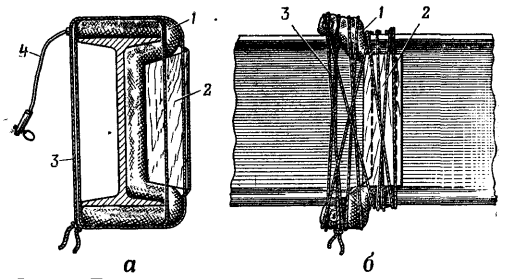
Подрывание стальной балки зарядом из пластичного ВВ:
